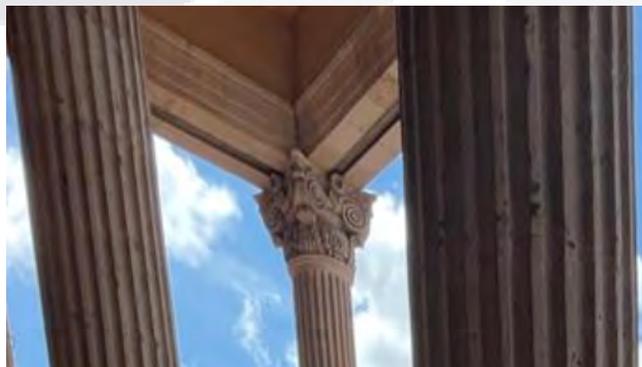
Capitel columnas en frontón con elemento metálico superior. Fuente: Elaboración propia. Fecha: 2022
